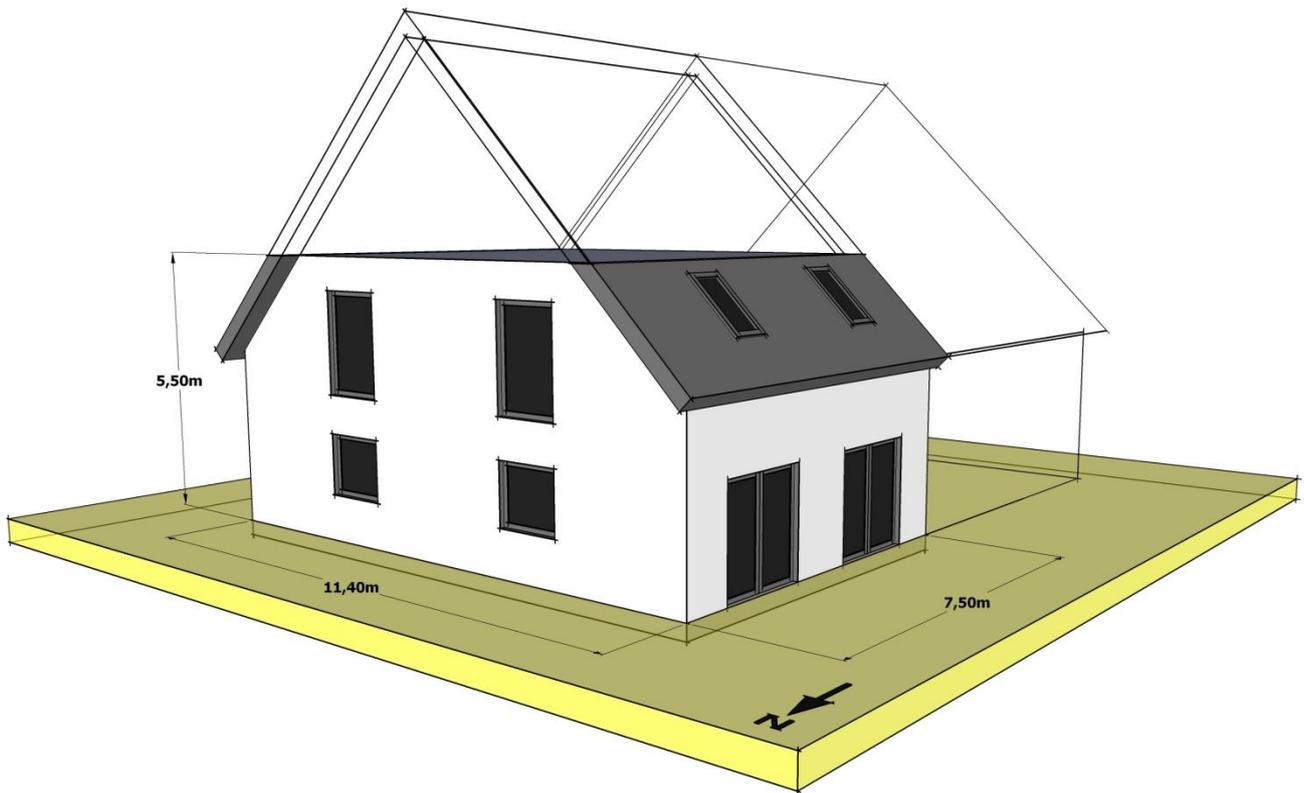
Doppelhaushälfte Nord – Ansicht Nord-West
